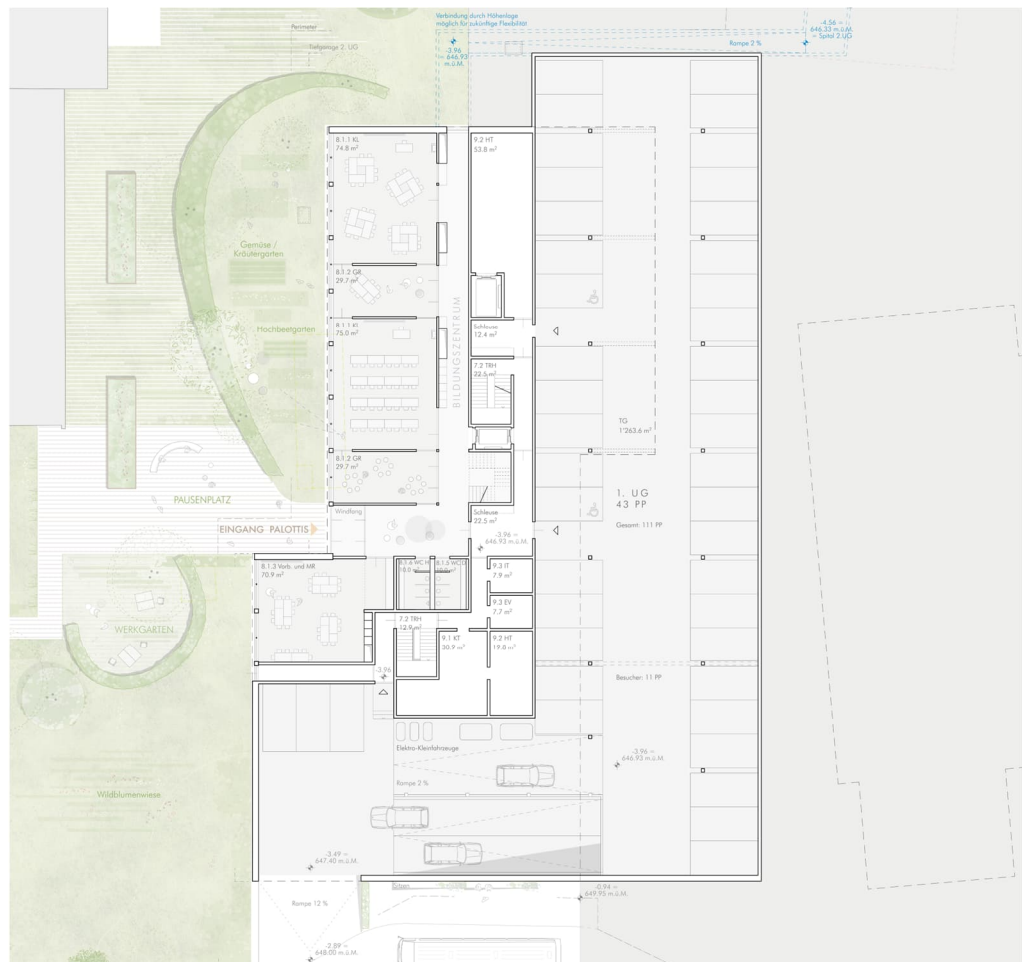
Grundriss Untergeschoss (1. UG) domum (massstablos)
